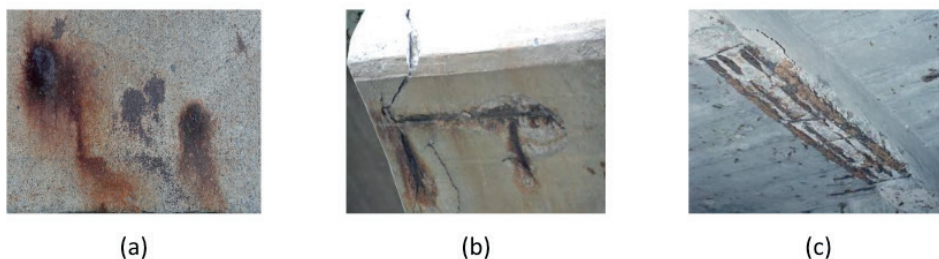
Efeitos da corrosão na camada de cobrimento de concreto: (a) manchas; (b) fissuras e rachaduras; (c) destacamento total.
